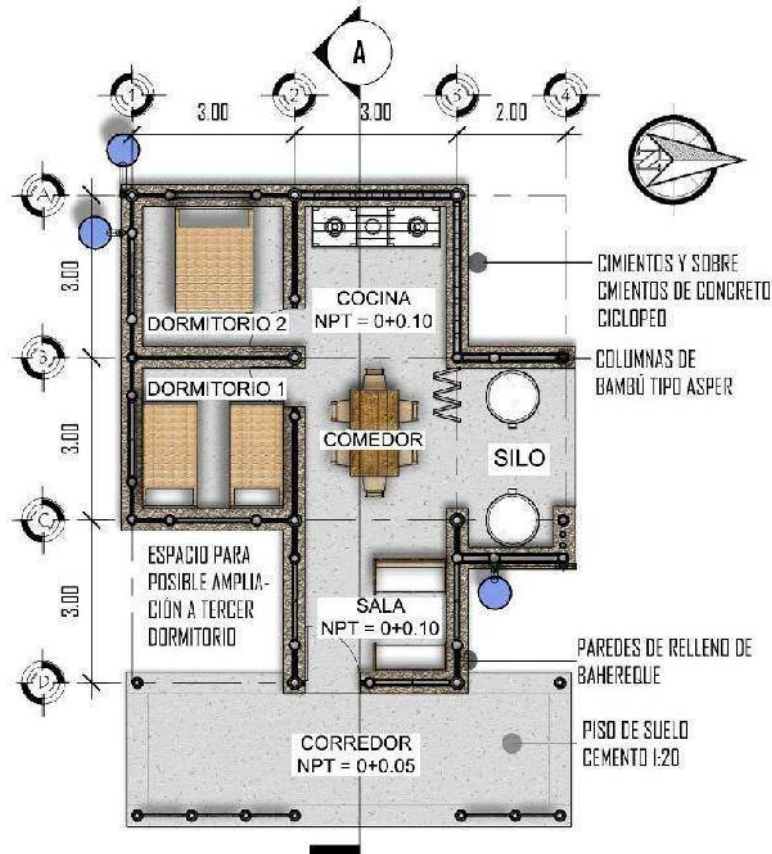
Planta de conjunto propuesta de vivienda #1
